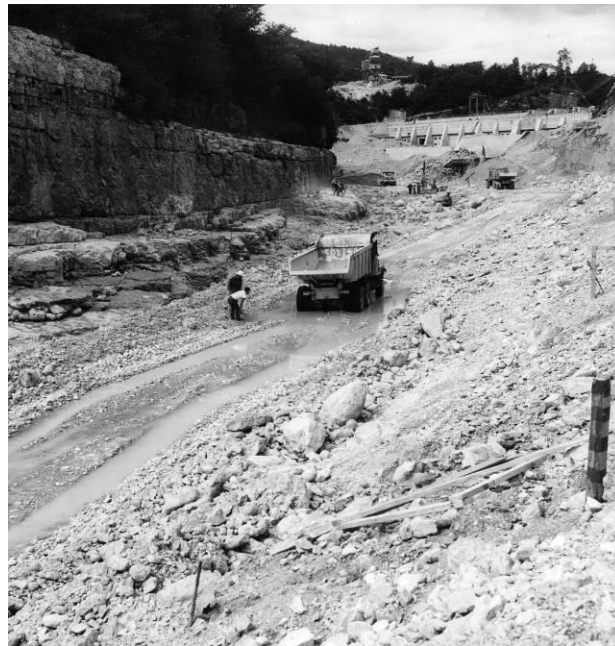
Travaux de terrassement lors de la construction du barrage de Saut Mortier
